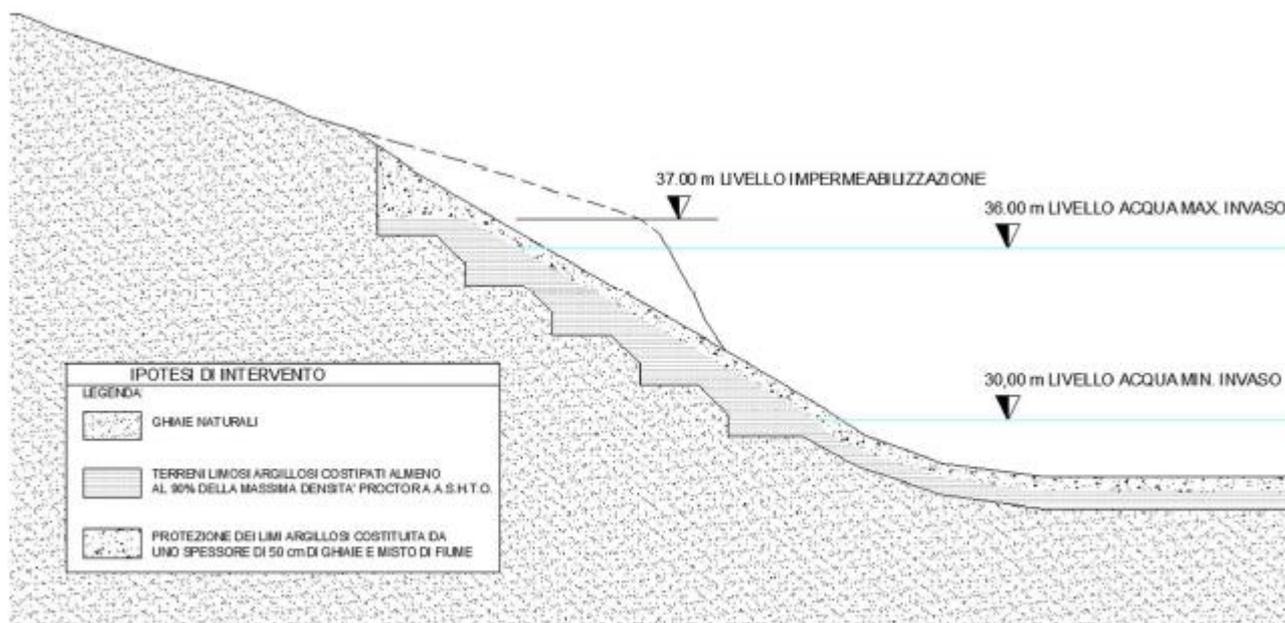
Sezione tipo dell'intervento di impermeabilizzazione del lago Azzurro
